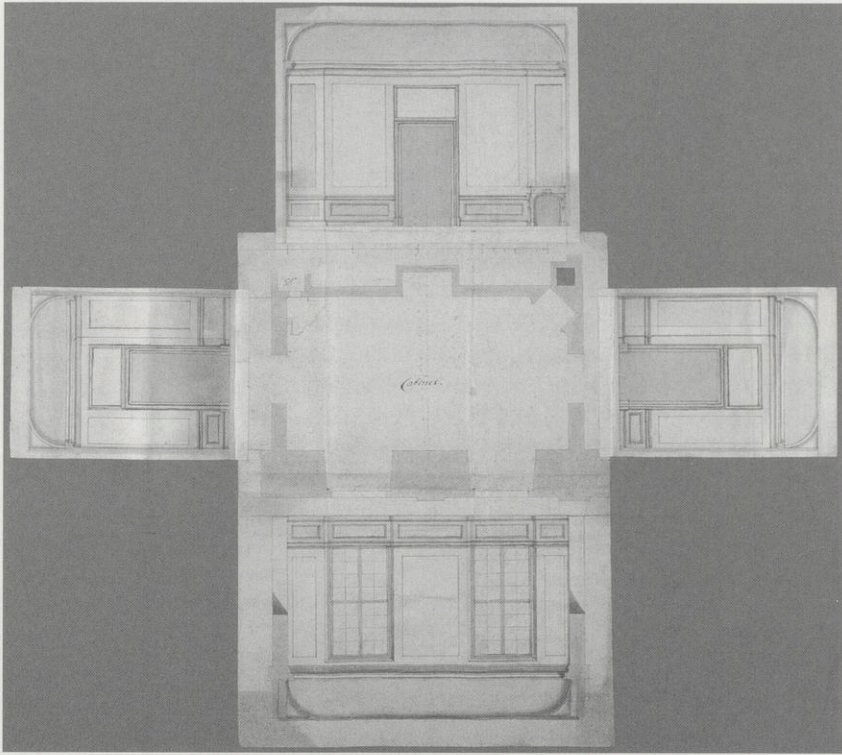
Stift Göttweig, Grundriss und Wandabwicklung des Kabinetts der heutigen Kaiserzimmer, um 1729 (GSSG, W c 031)
